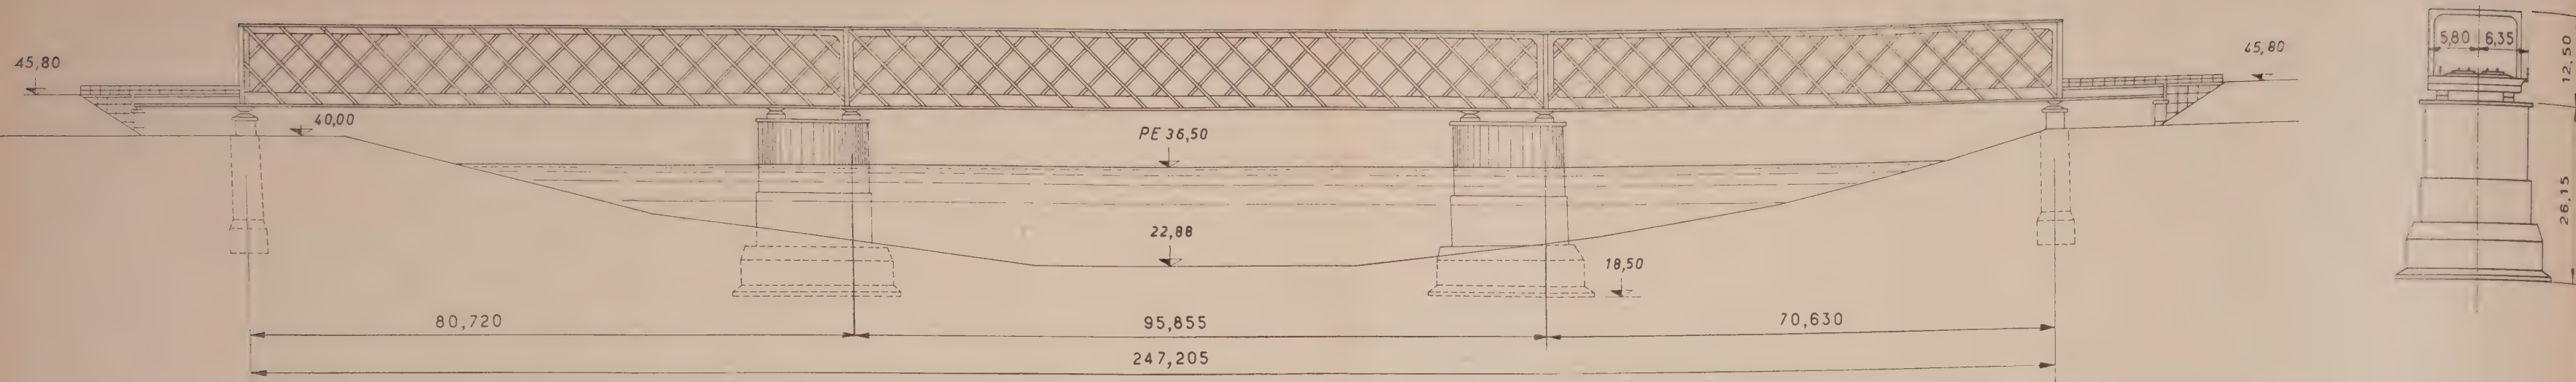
Pont-rail sur le canal de fuite. Élévation et coupe transversale.
